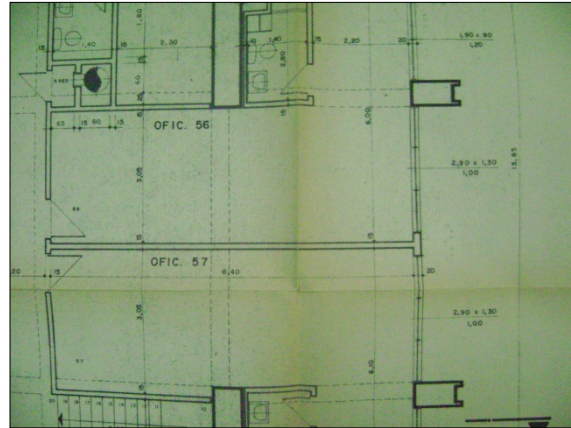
Fotografía de Plano de Arquitectura de Planta 5
